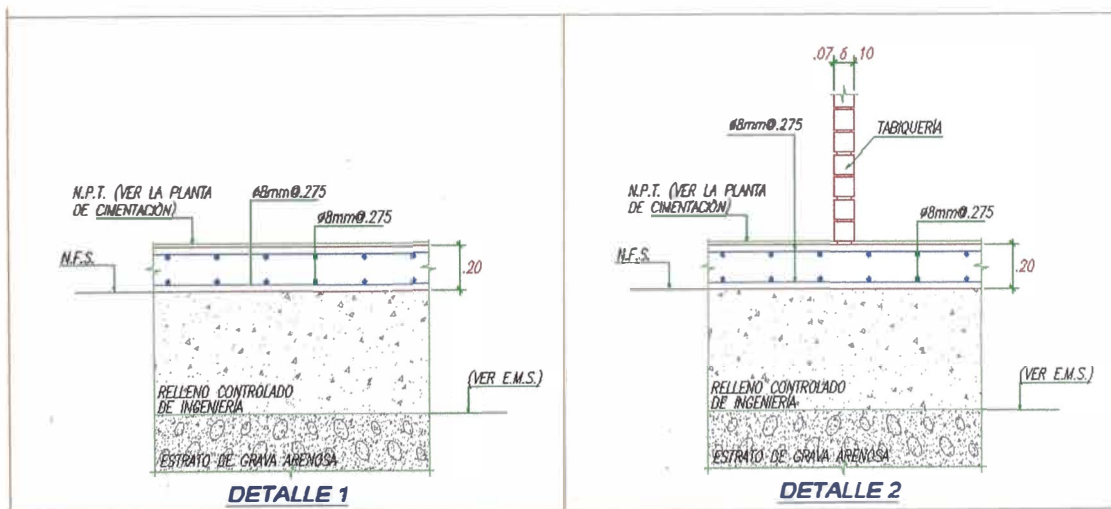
Detalles típicos para placa de cimentación edificio de 5 pisos
